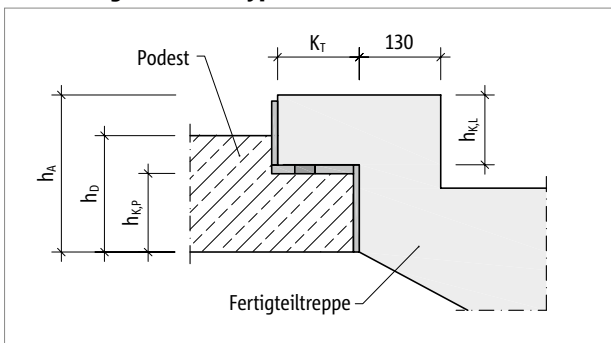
Schöck Tronsole® Typ BZ: Bemessung
